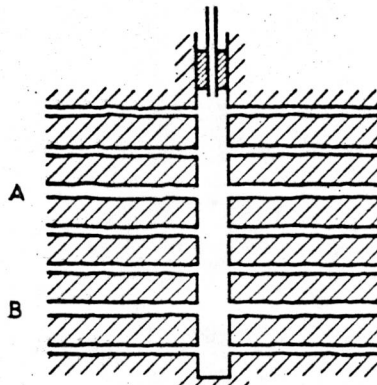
Inyección de varias fisuras paralelas.(Ref. H. Cambefort)
